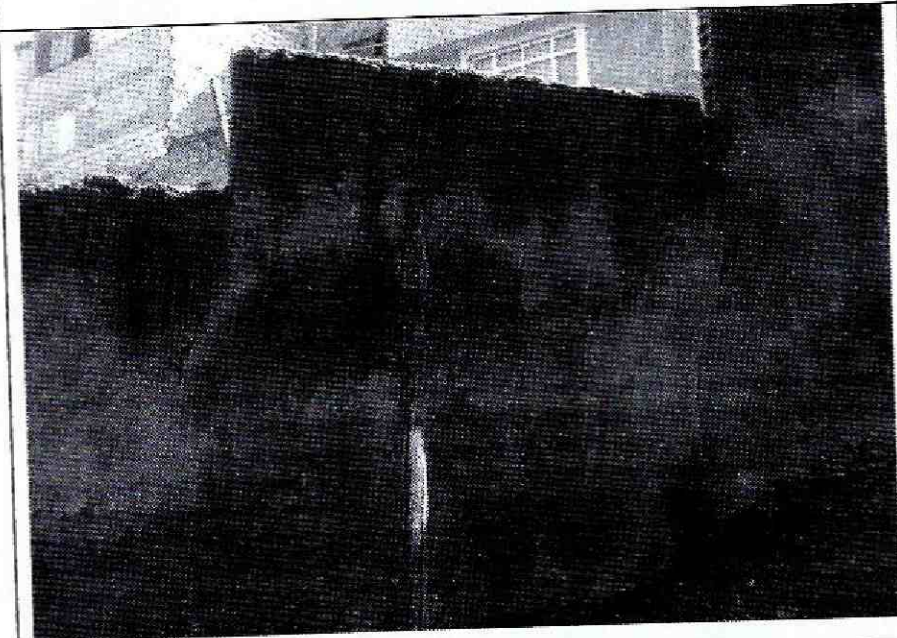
Apuntalamiento provisional en la zona central del muro de cerramiento.
